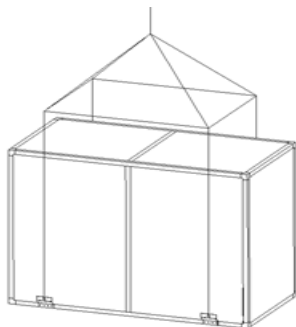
Zabezpieczenie centrali podczas transportu pionowego w przypadku naroży fundamentowych na końcach bloku
